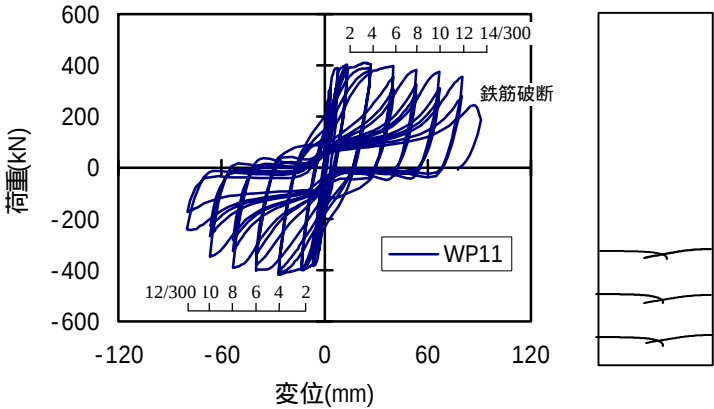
試験体 WP11 の荷重 - 変位関係とひび割れ状況
